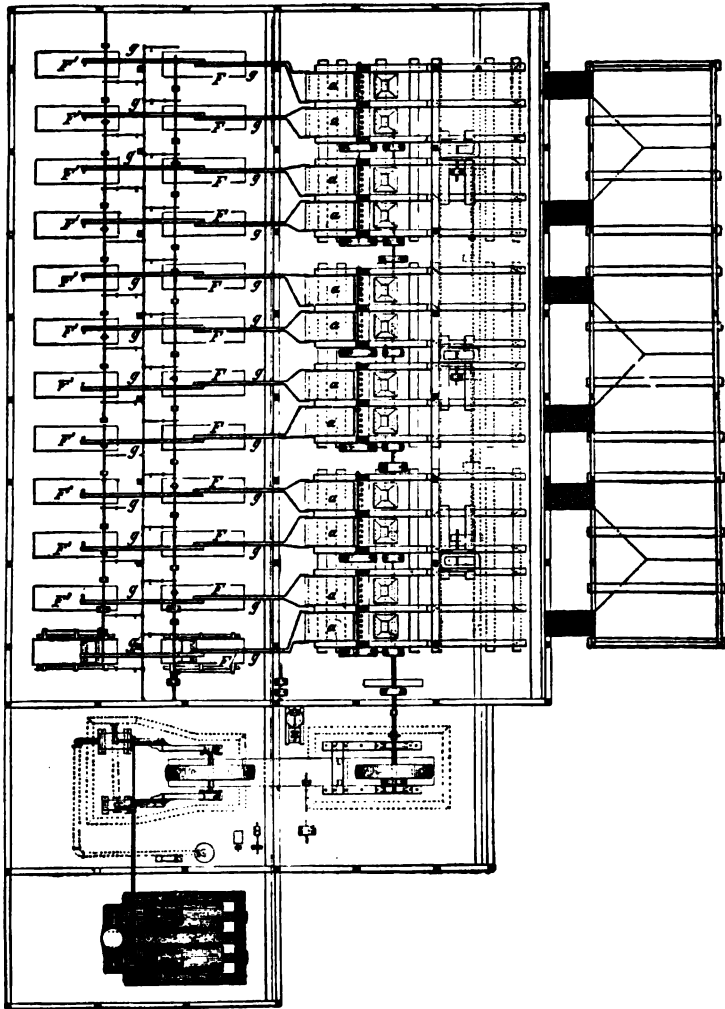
Plan d'un atelier de bocardage de 60 pilons avec frue vanners.
